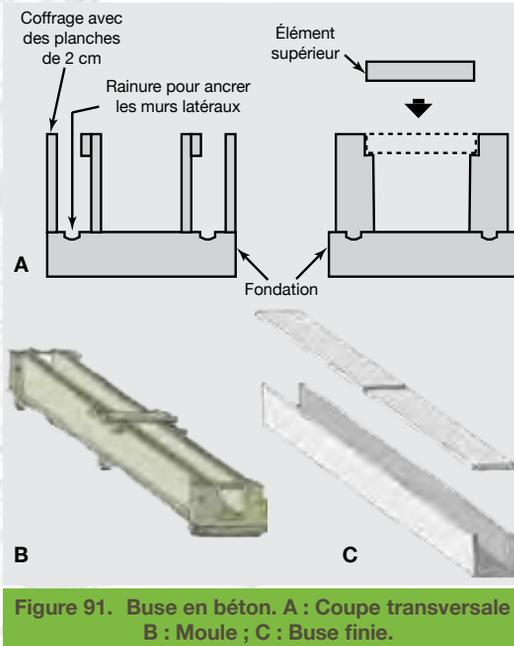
Buse en béton. A : Coupe transversale ; B : Moule ; C : Buse finie.
